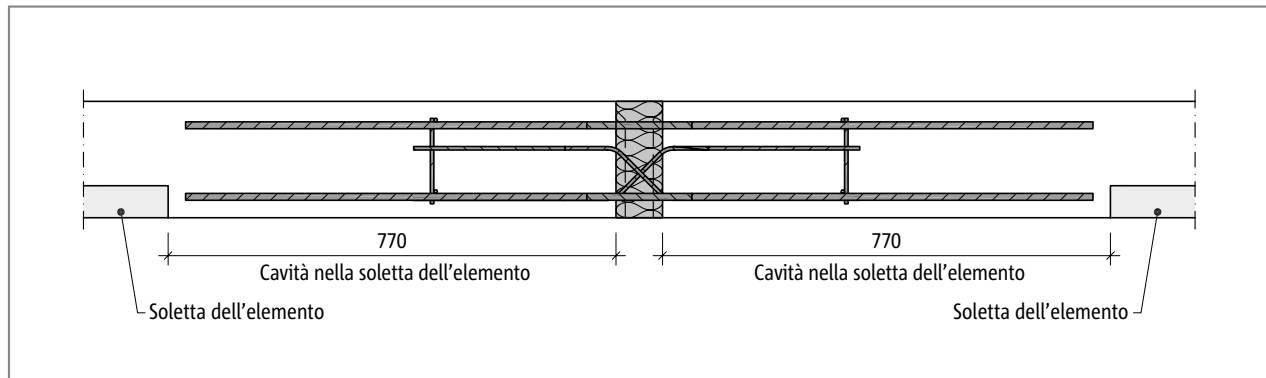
Schöck Isokorb® tipo D: solaio dell'elemento con cavità e Isokorb tipo D
